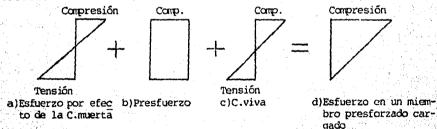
Distribución de esfuerzos en la sección de una viga presforzada concéntricamente.
